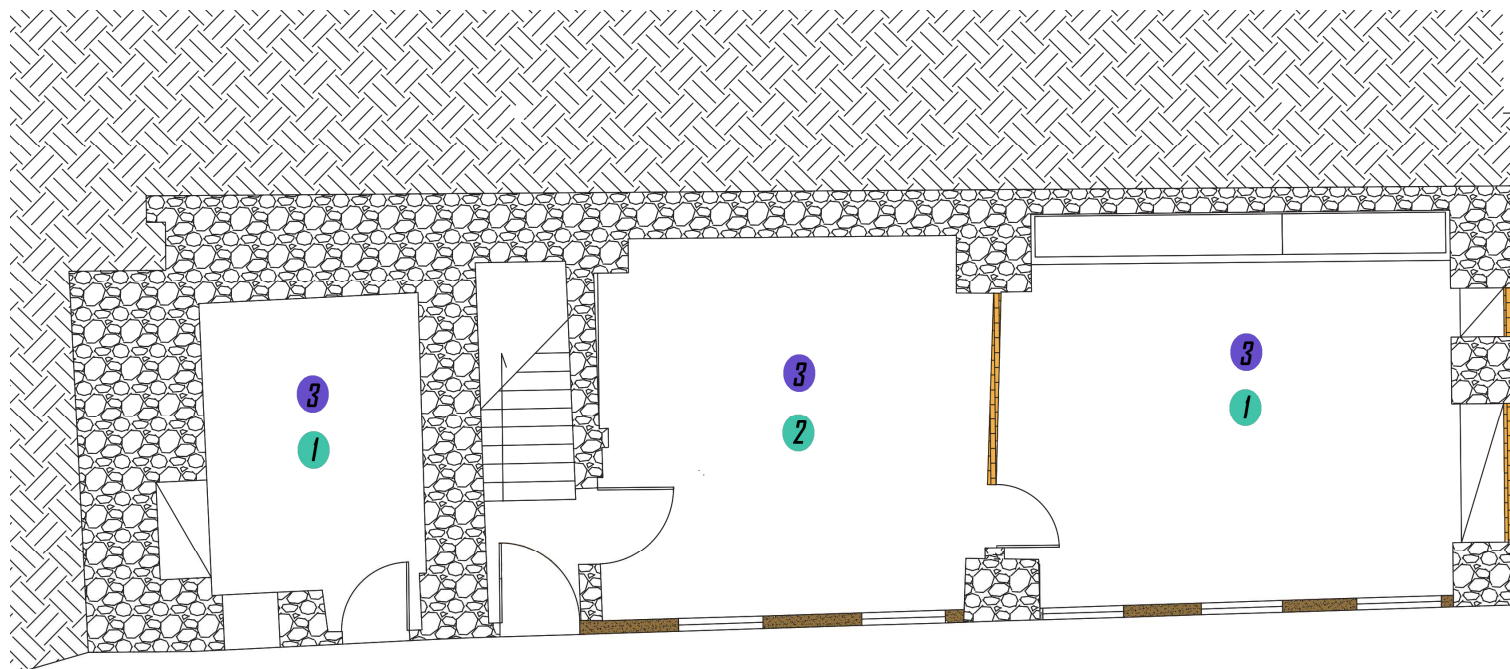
Planta de Implantação do Edifício Casarão Rocha Lagoa.
